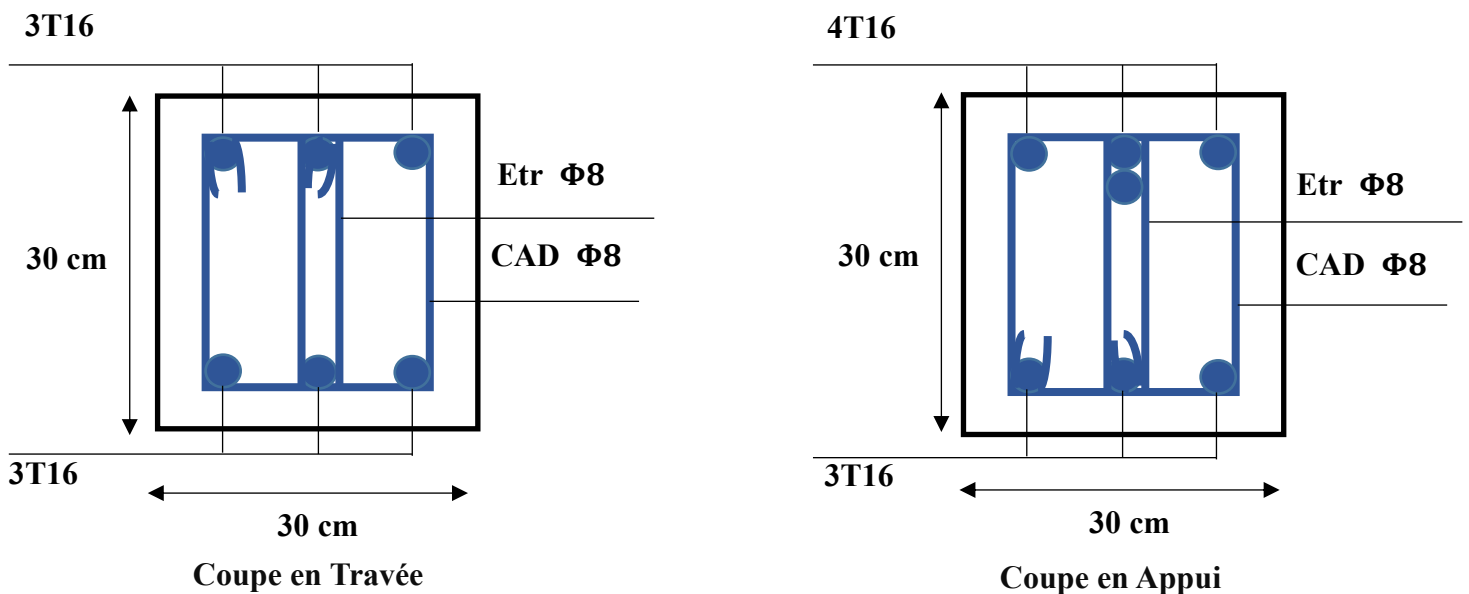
dispositions du ferrailage longitudinal du poutre secondaire
